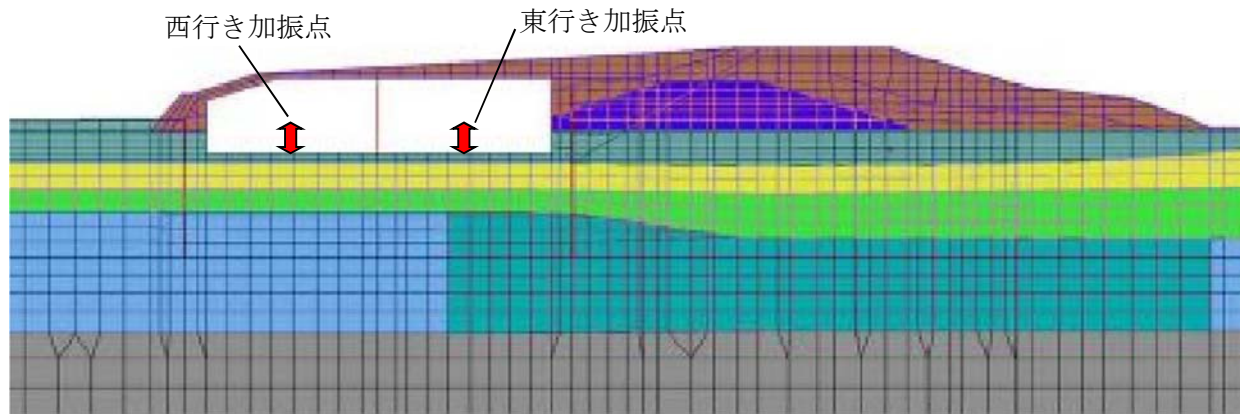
解析モデル 交通荷重の加振点位置(一般標準断面 No.204)
